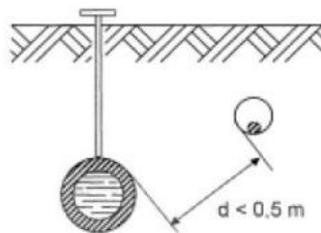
disegno esemplificativo di protezione e segnalazione delle tubazioni
